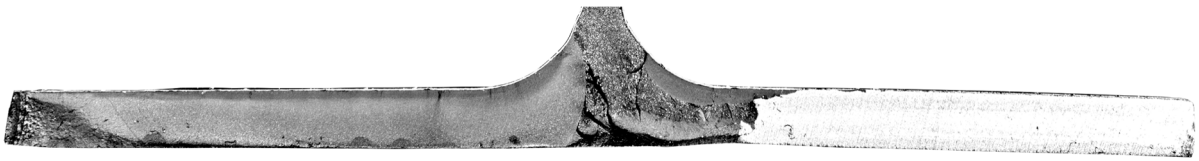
Bruchbild Versuchsträger T2.1 AW - Detailansicht
